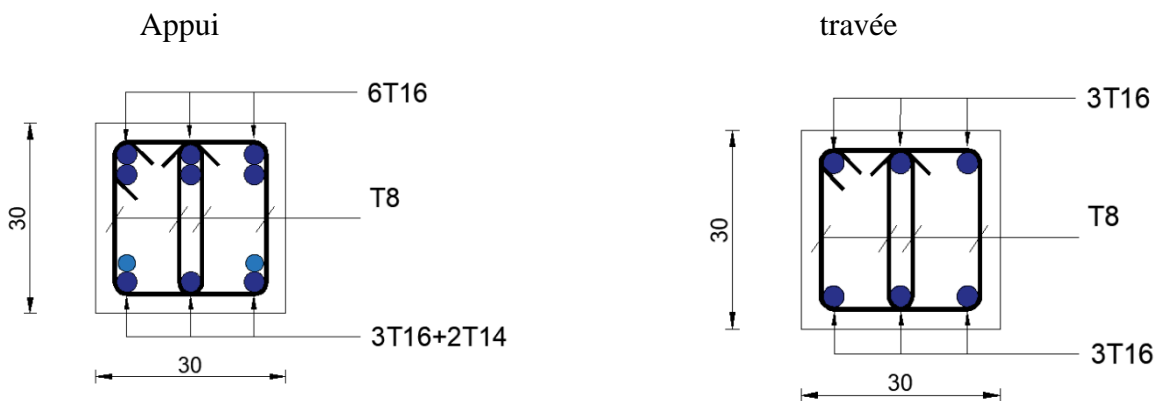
schéma de ferrailages des poutres non porteuse (8^{ème} étage---RDC)
